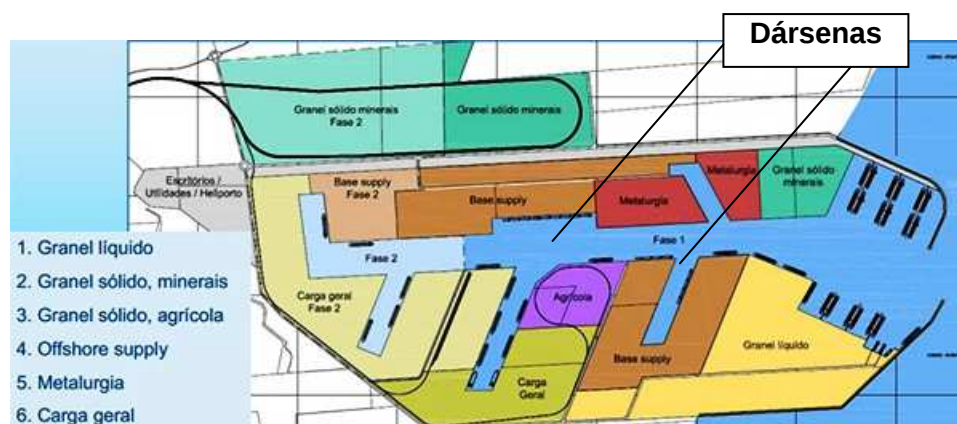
Porto Central – Layout geral com detalhe das Dársenas – fonte: seculodiario.com.br
